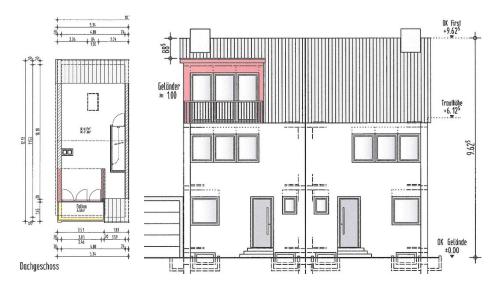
Grundriss und Straßenansicht des geplanten Vorhabens
